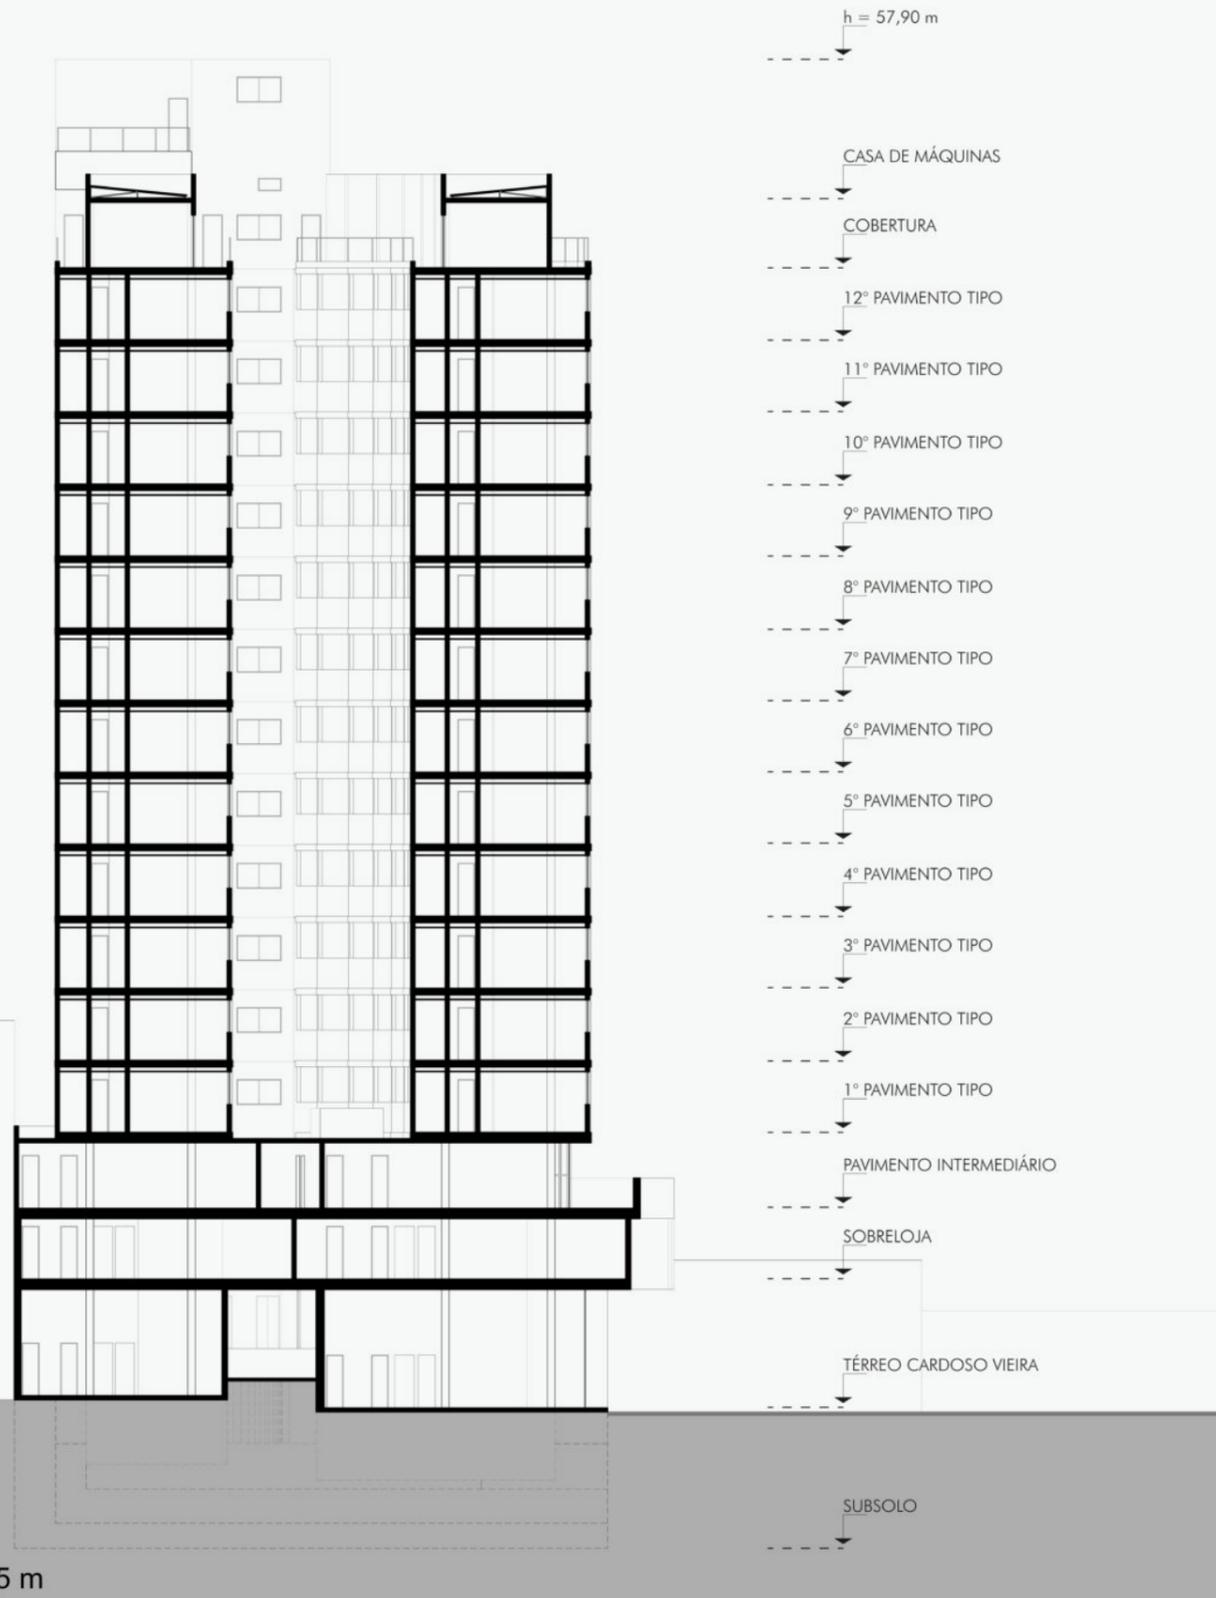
| Esquemática de Corte BB e volumetria, construído. Fonte: Autor (2022).
